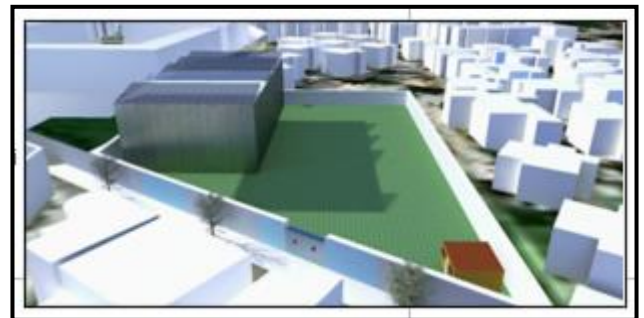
plan schématique de hangar/ Source : traiter par l'auteur.
